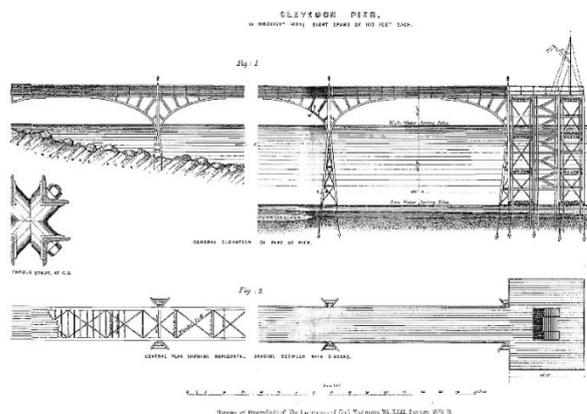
Planta y sección del muelle. (Grover (o.c. pág. 135))
